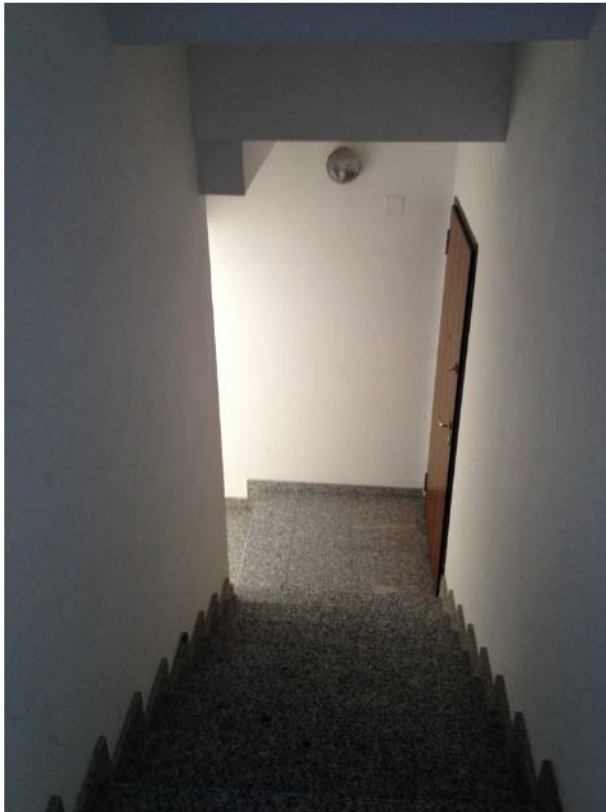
corridoio appartamento 1 al primo piano)
